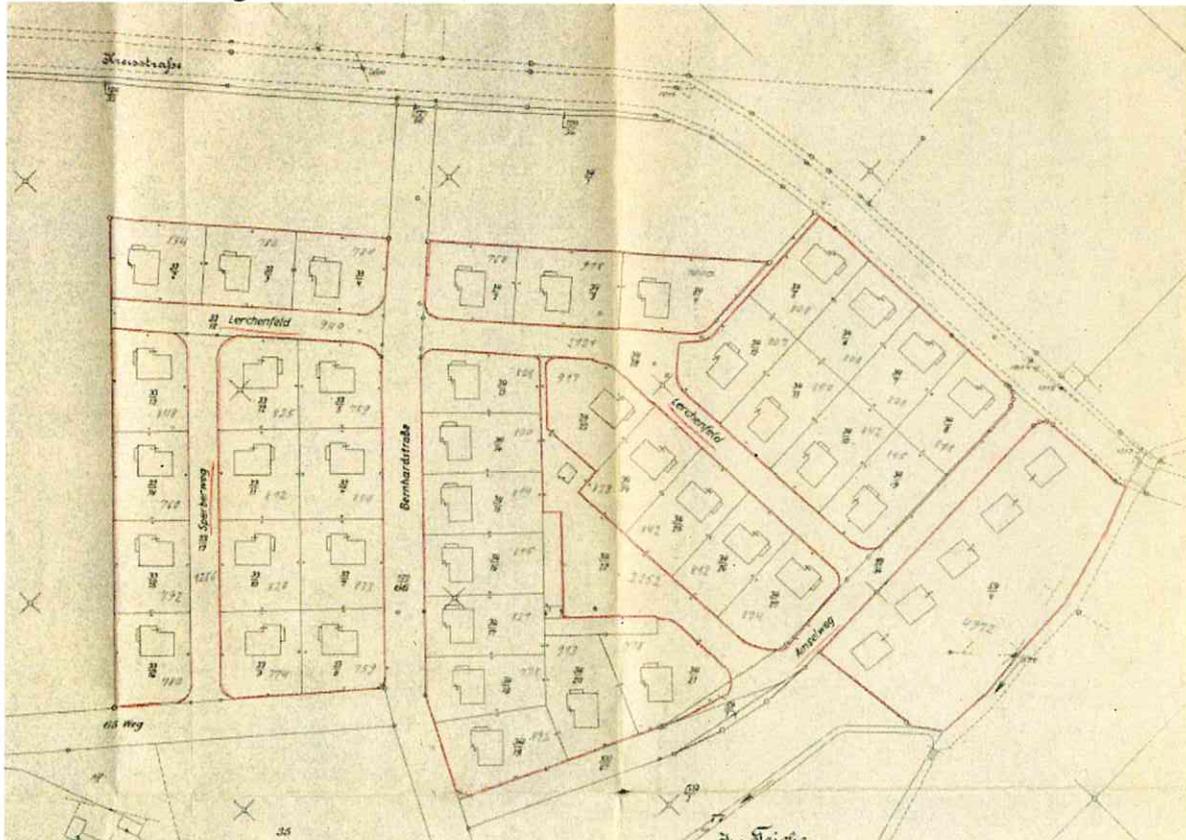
Lageplan der Siedlung mit ursprünglichen Straßennamen, Teil des Bauantrages
